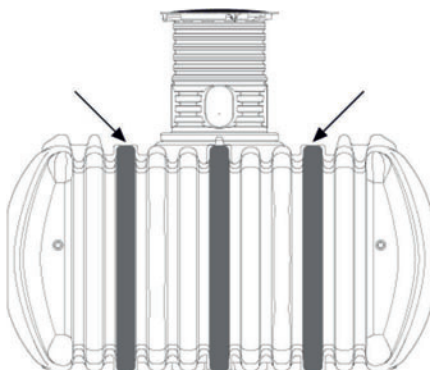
Vue en coupe des tubes de renfort – FLAT L
